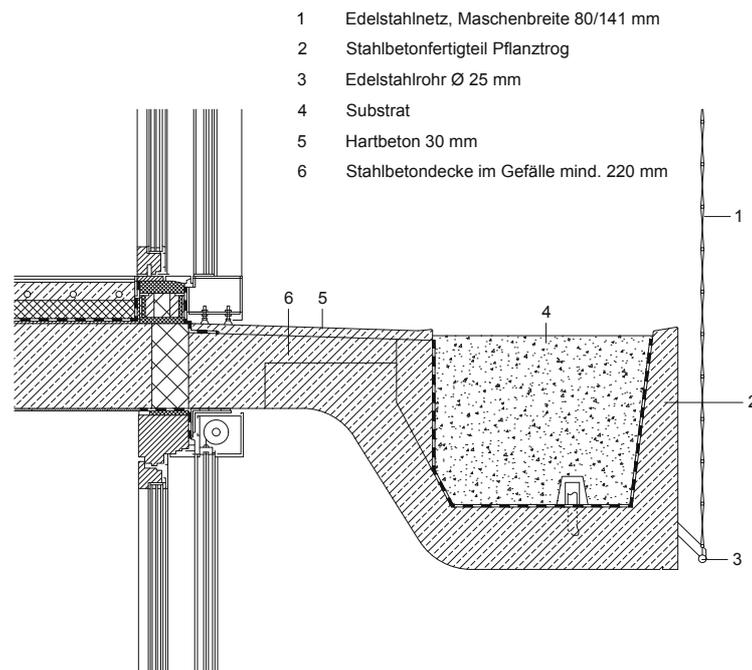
Fassadenbegrünung Garden Tower – Aufbau, eigene Darstellung © DETAIL Business Information GmbH [44]
